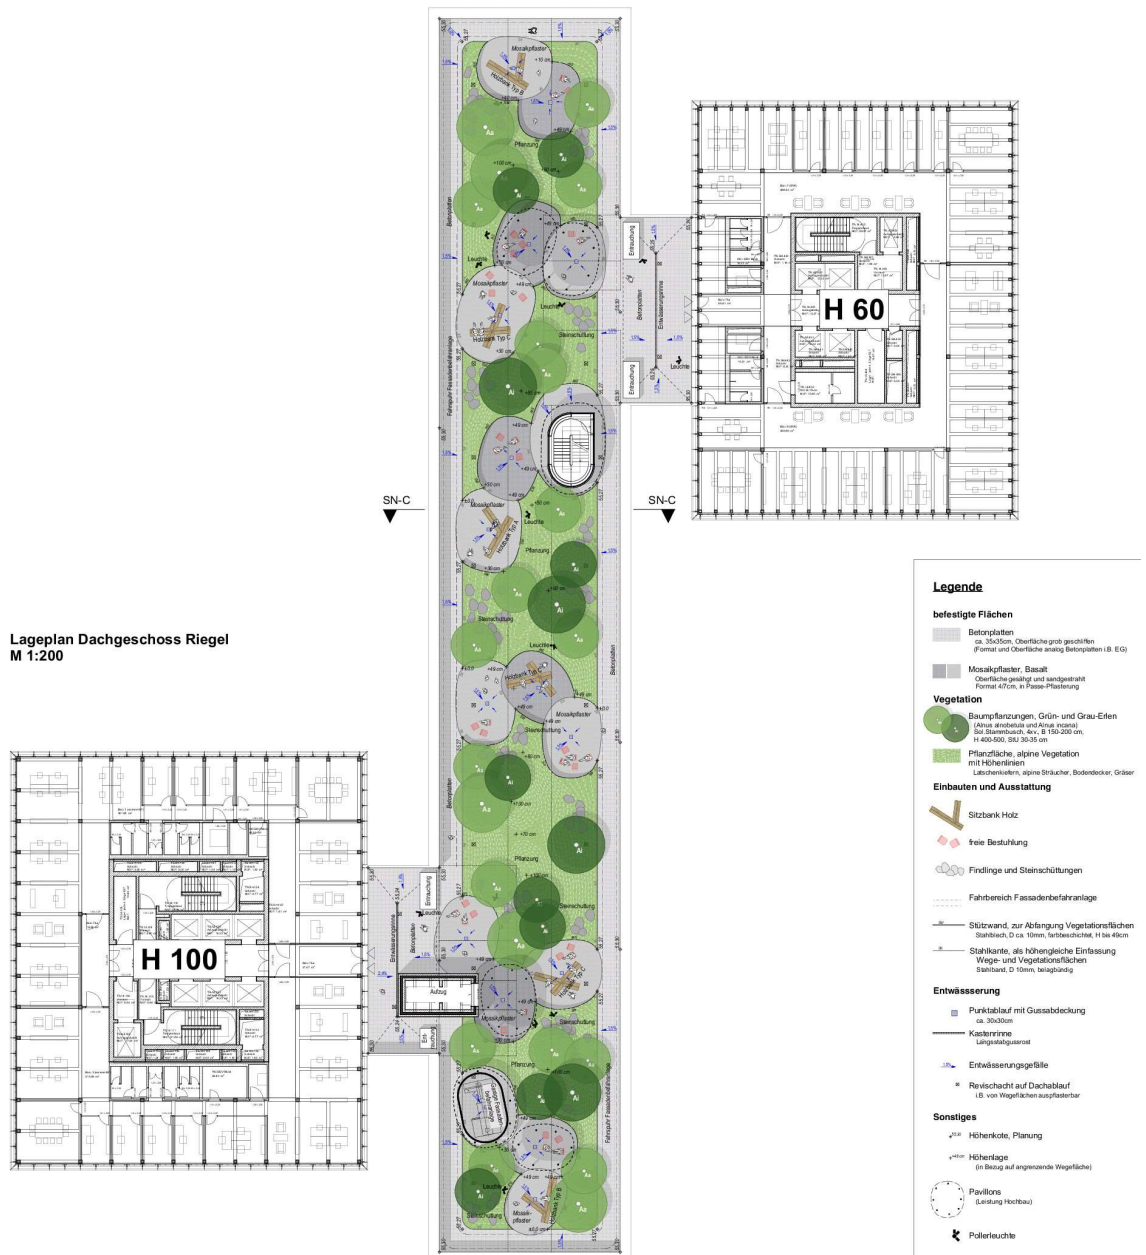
Draufsicht mit Grundriss Dachgeschoss RS76 [18].
